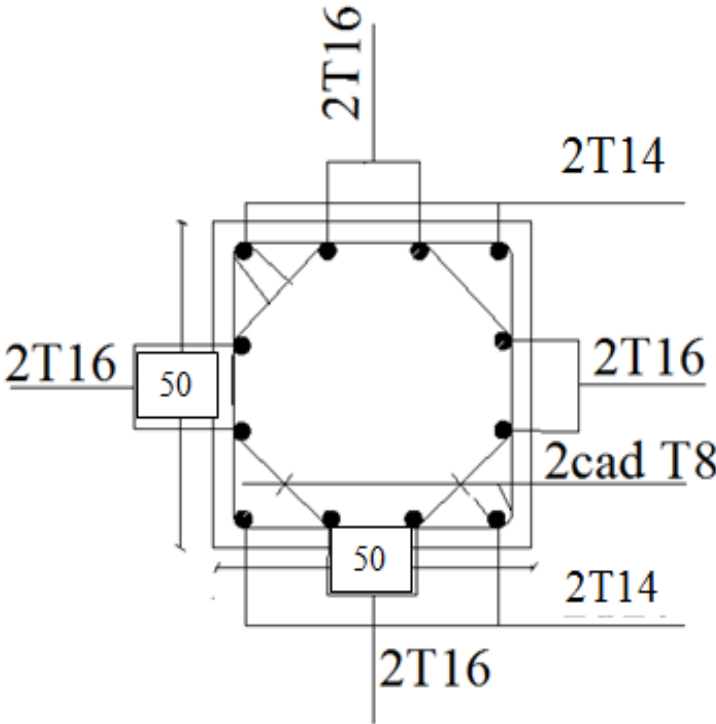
Exemple du ferrailage du poteau (50x50)
